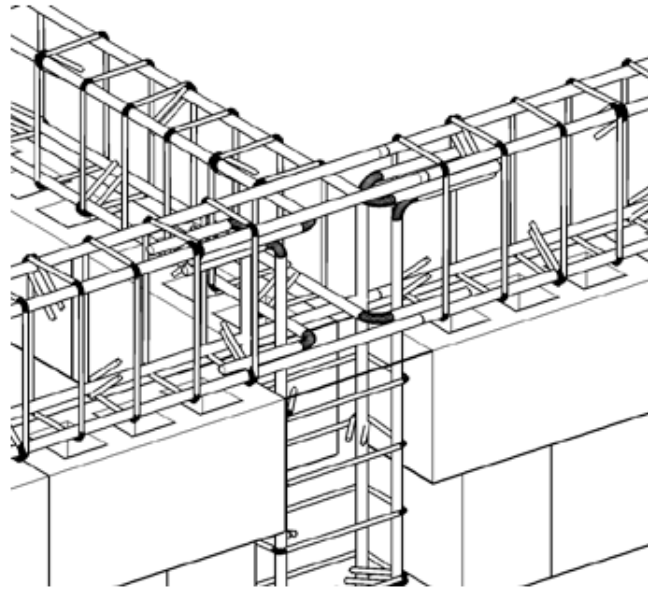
Detalle de las barras de refuerzo en el encuentro de muros en T (Totten, 2010)
